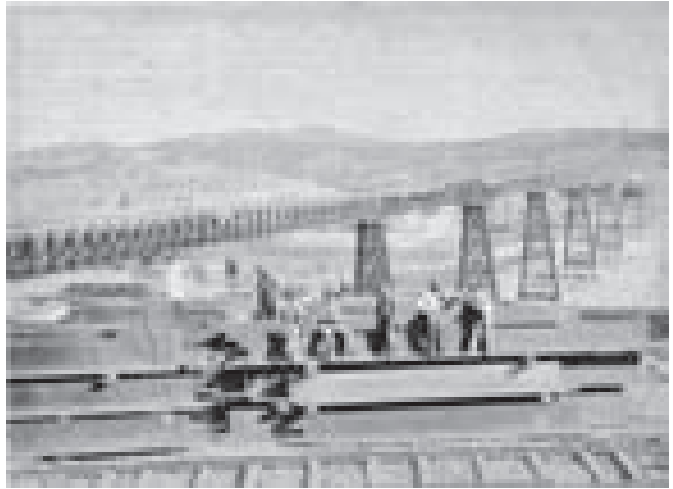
Trabajos de construcción del Puente del Hacho. 1895. Foto Rafael Garzón. Archivo de Carlos Sánchez.
